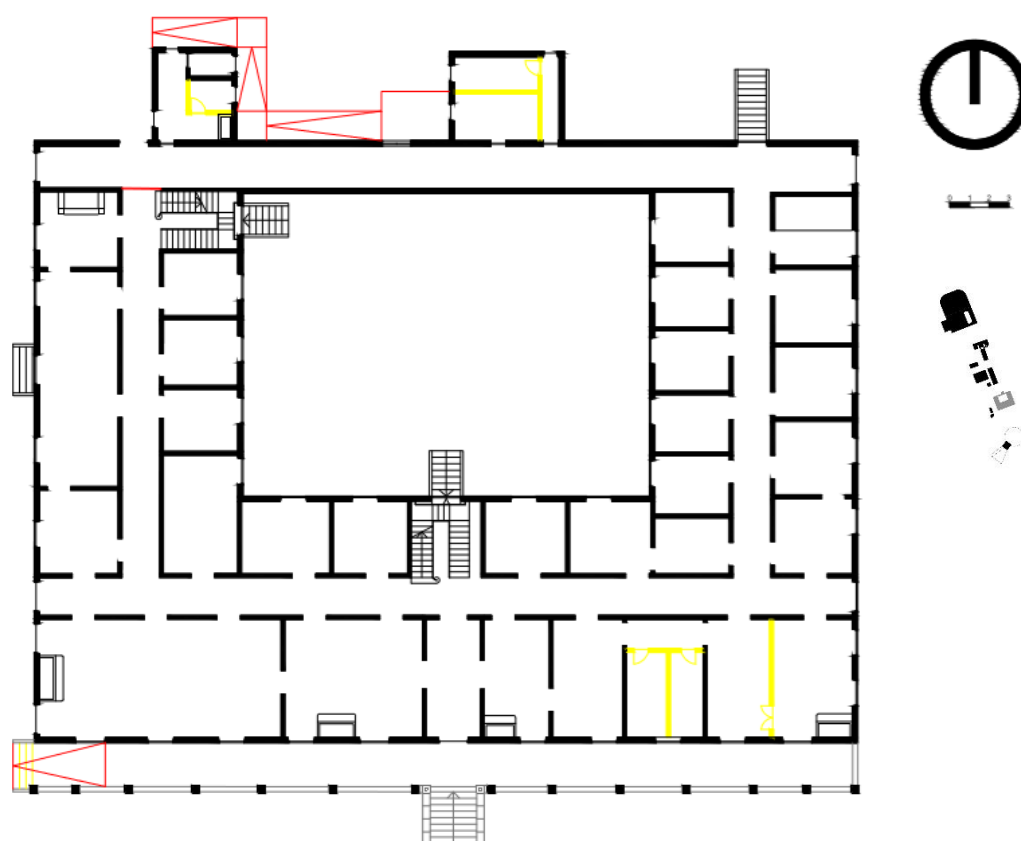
Planta amarelos e encarnados do Palácio do Vidigal - cota 95
